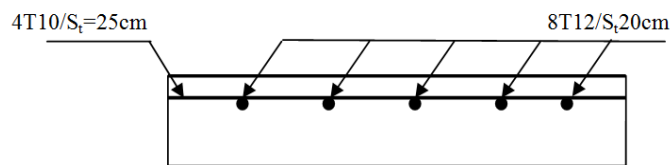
Schéma de ferrailage de palier intermédiaire
